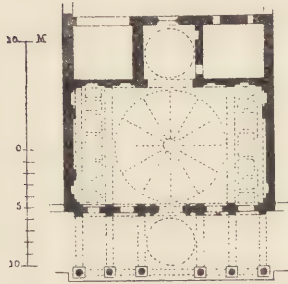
Capp. Pazzi zu Florenz. Grundriss. (Nach Paulus.)
